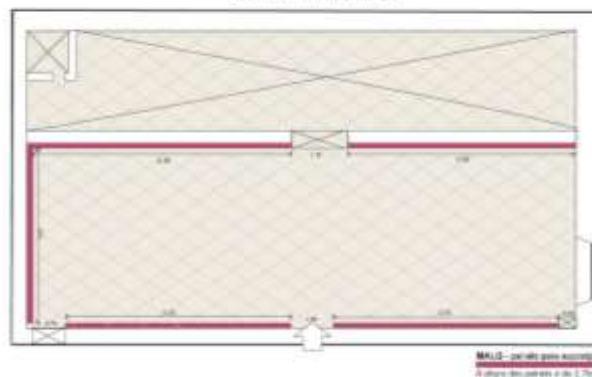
Planta Baixa Galeria Leopoldo Gotuzzo.
